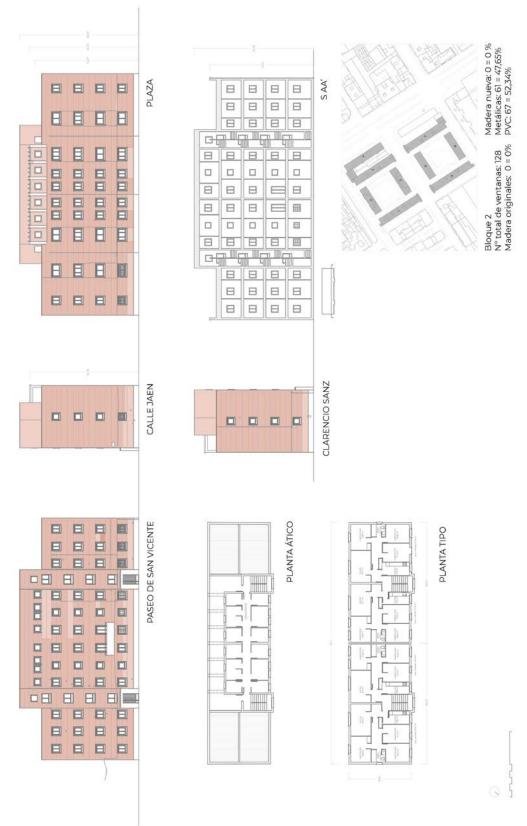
c.20. Planimetría del BLOQUE 2. Obra del Hogar Nacional Sindicalista
